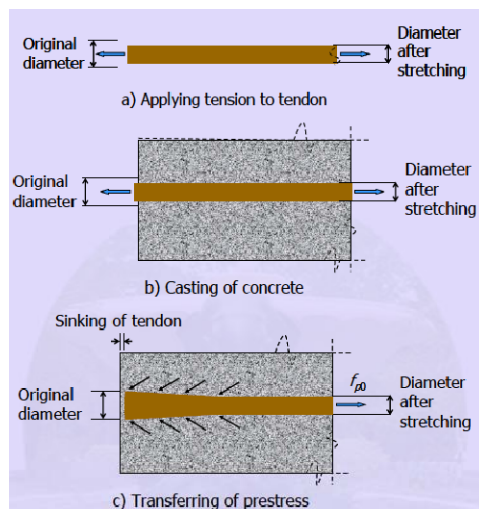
Deformirana prednapeta armatura [Prestressed concrete structures, Sengupta A., Menon D., poglavje 7-1.1]
